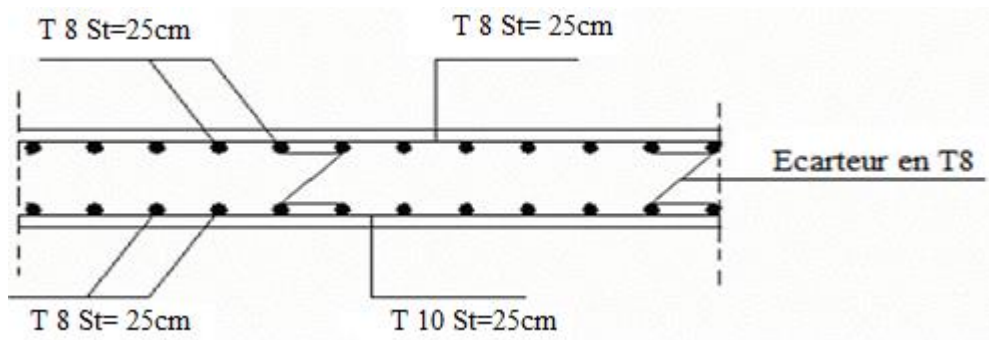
Ferrailage de la dalle pleine rectangulaire.
